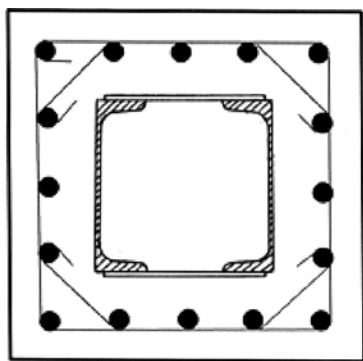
Схема поперечного сечения ТЖБ колонны с решетчатой трубой из двух швеллеров, соединенных планками (или стержнями) с малым шагом по высоте
